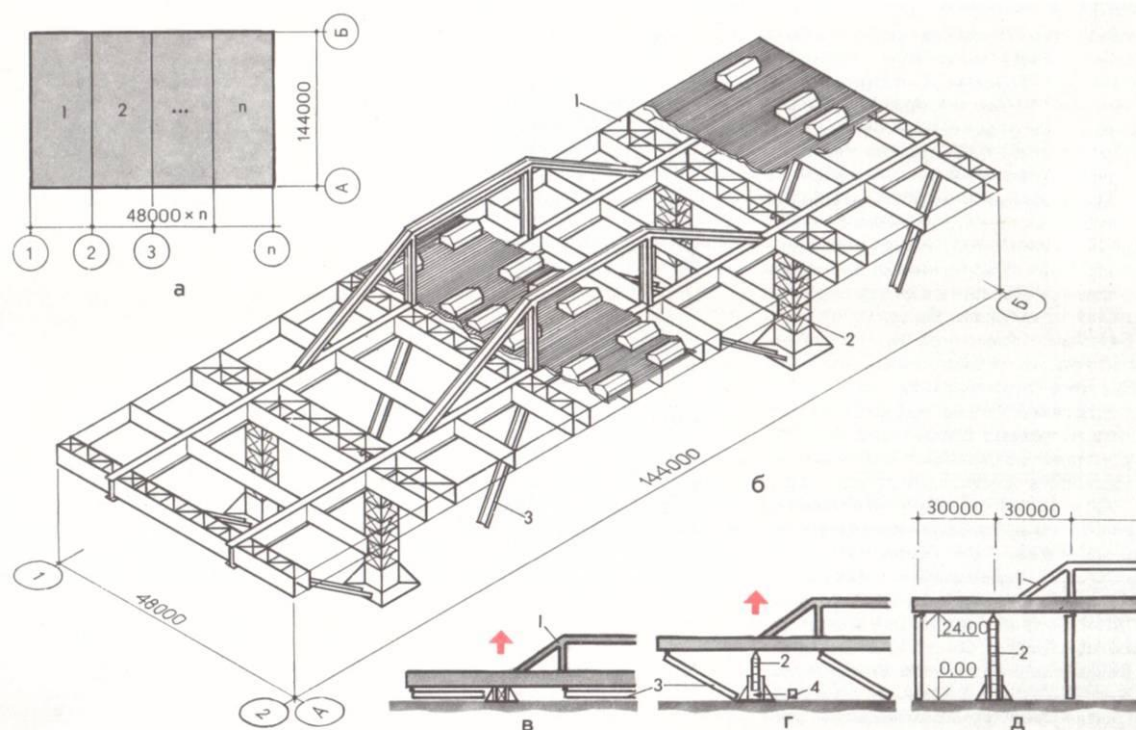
Метод монтажа покрытия: *а* – план покрытия; *б* – промежуточный этап подъема; *в–д* – схемы монтажа по этапам; 1 – монтируемый блок; 2 – подъемное устройство; 3 – колонны; 4 – подрачиваемый элемент подъемника
